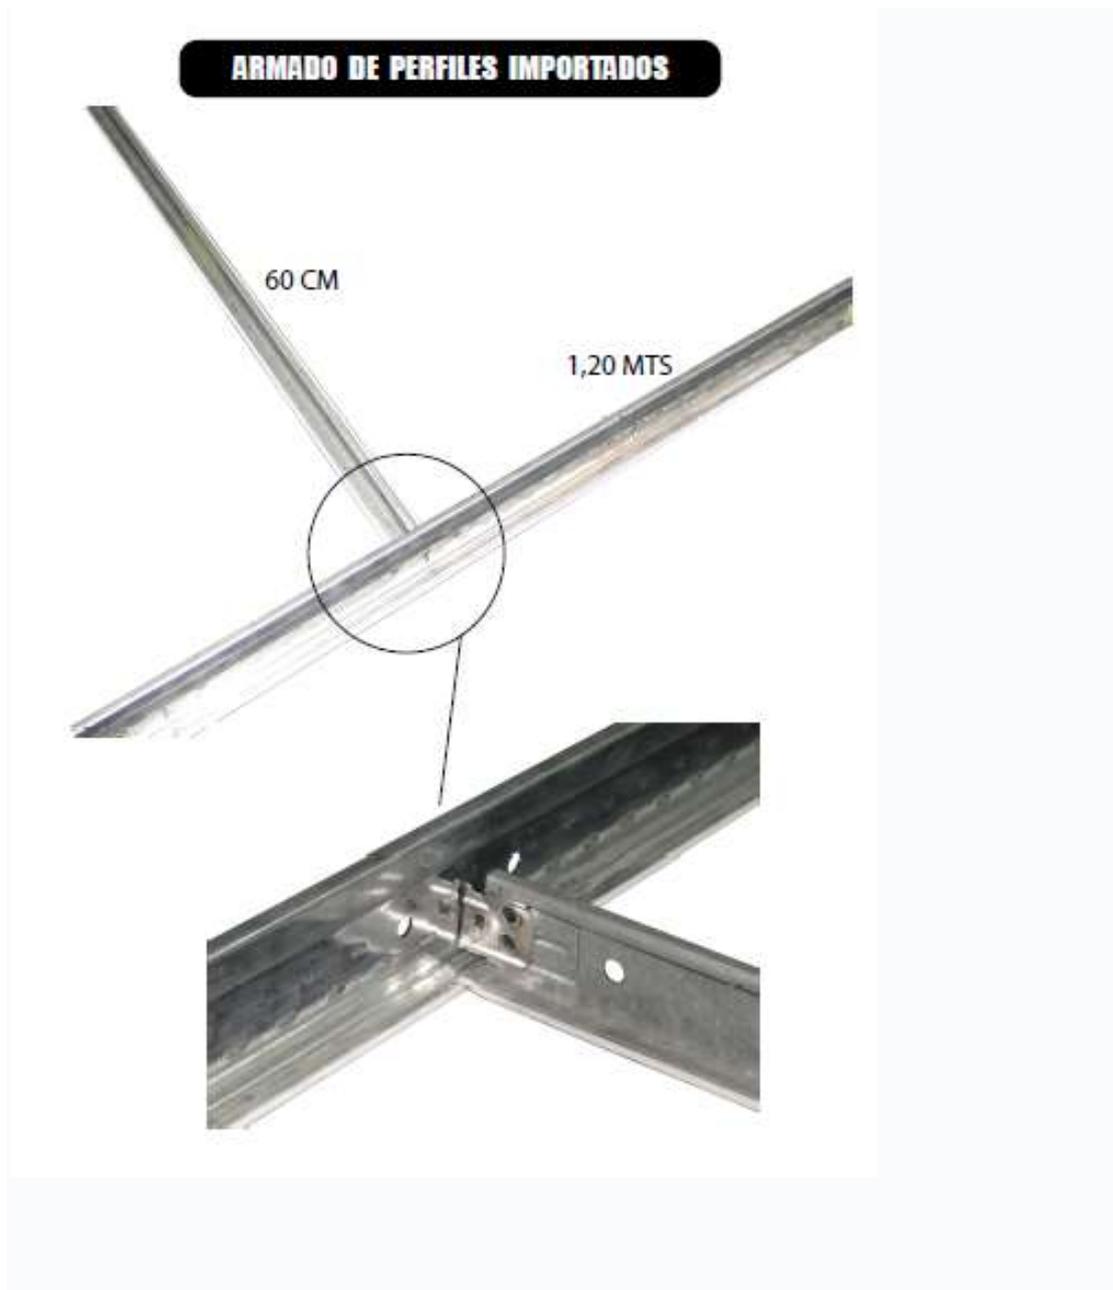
Armado de Perfilera Metálica Maviju.
